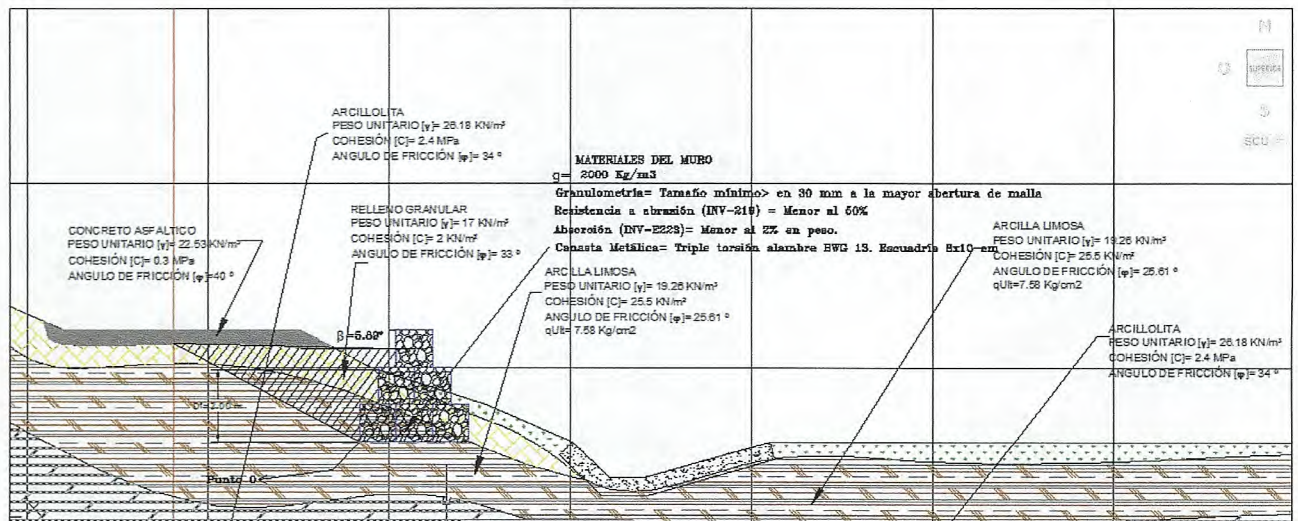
Esquema de Muro de Contención en Gavión Sitio Inestable N°3
